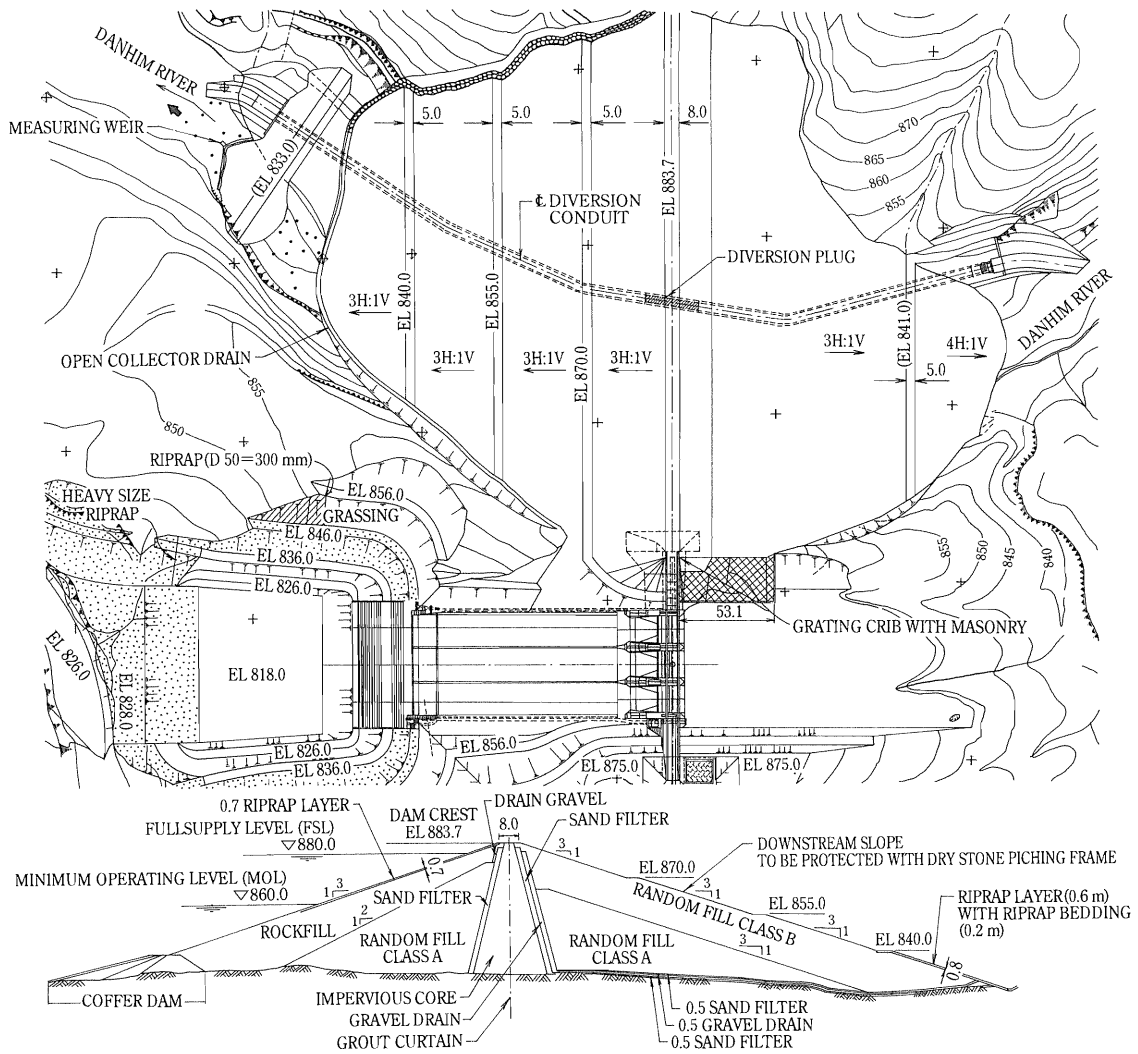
ダニムダムと洪水吐 (上：平面図, 下：ダム標準断面図)
